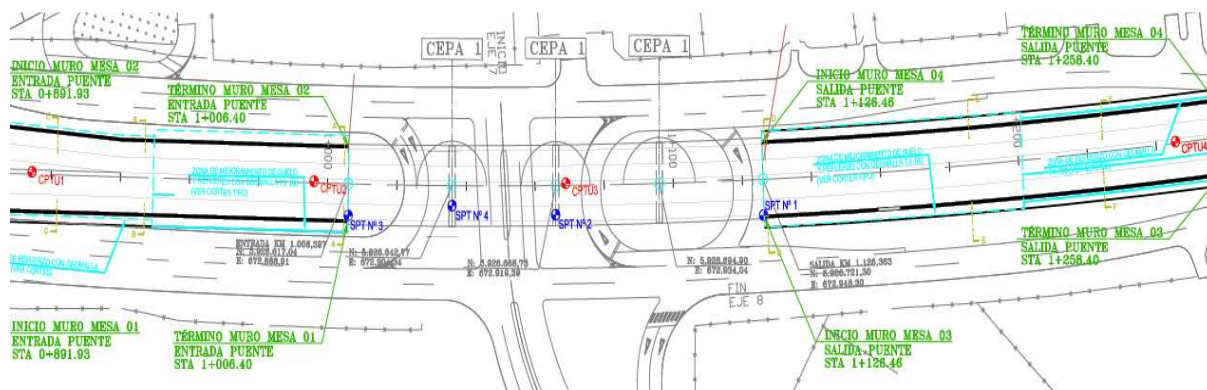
Ubicación en planta de prospecciones realizadas durante la etapa de proyecto y construcción
